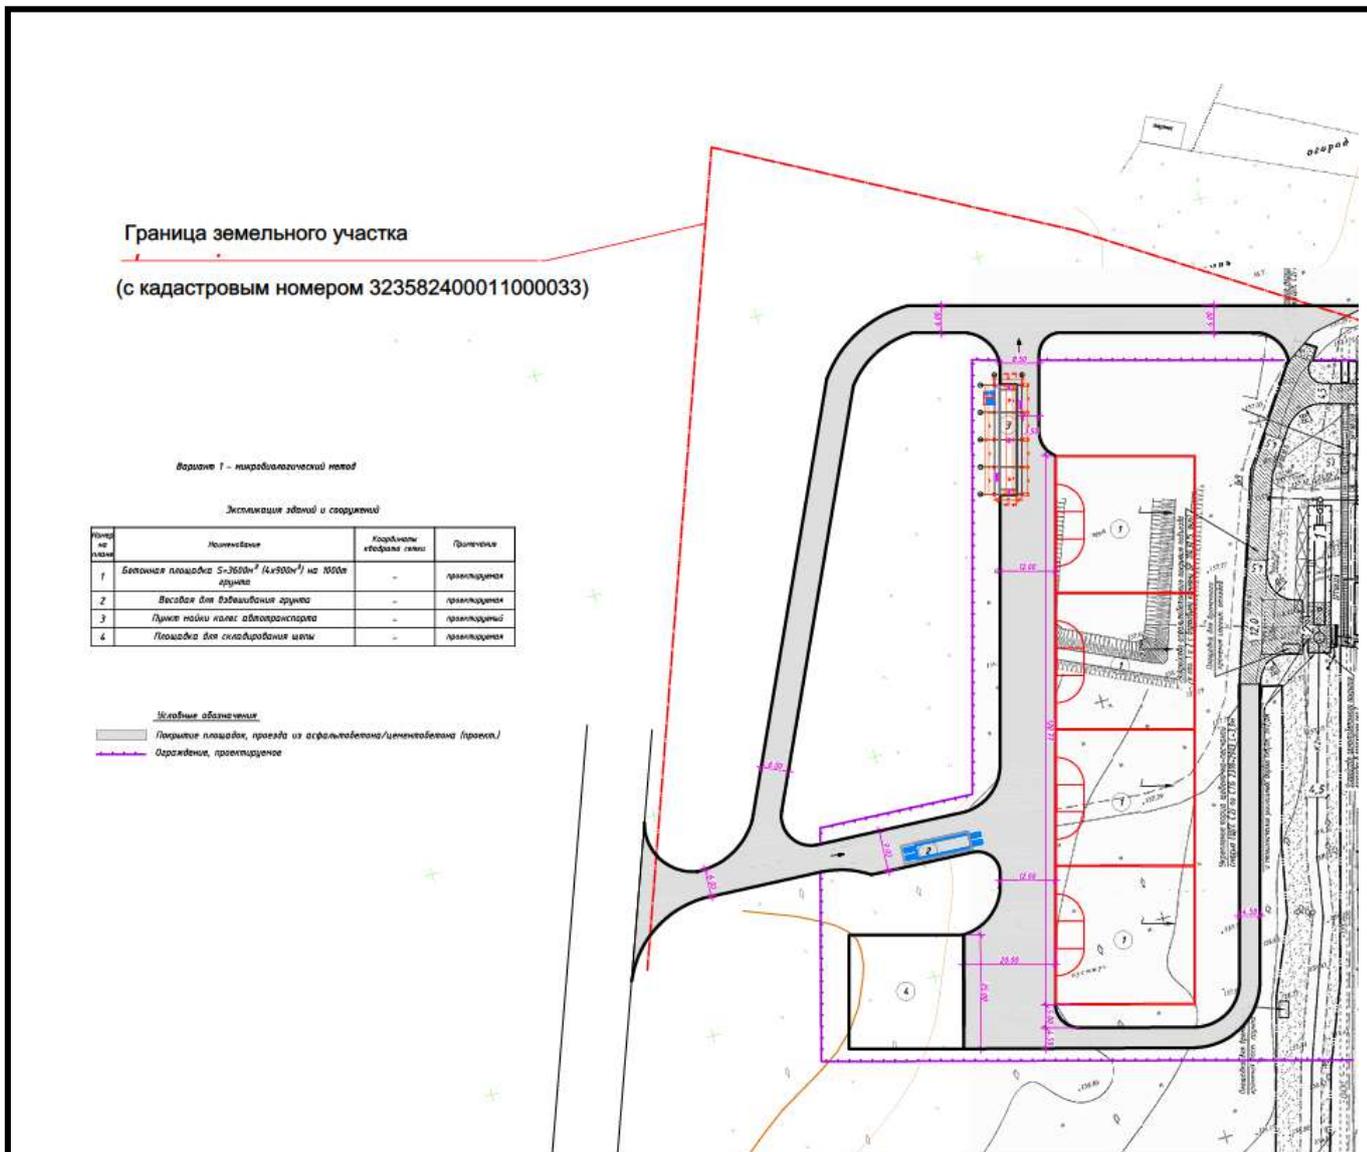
Схема генерального плана строительства объекта по использованию отходов производства биологическим методом
